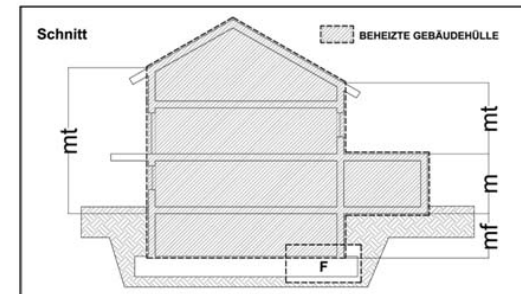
anzusetzende Bruttogeschosshöhe-gebäudehöhe der wärmeübertragenden Umfassungflächen mt ist, wie oben dargestellt, zu messen; Bruttoaußenmaß des Kreuzungspunktes Dach-Wand, mf ist abhängig vom Gründungstyp Detail F.
